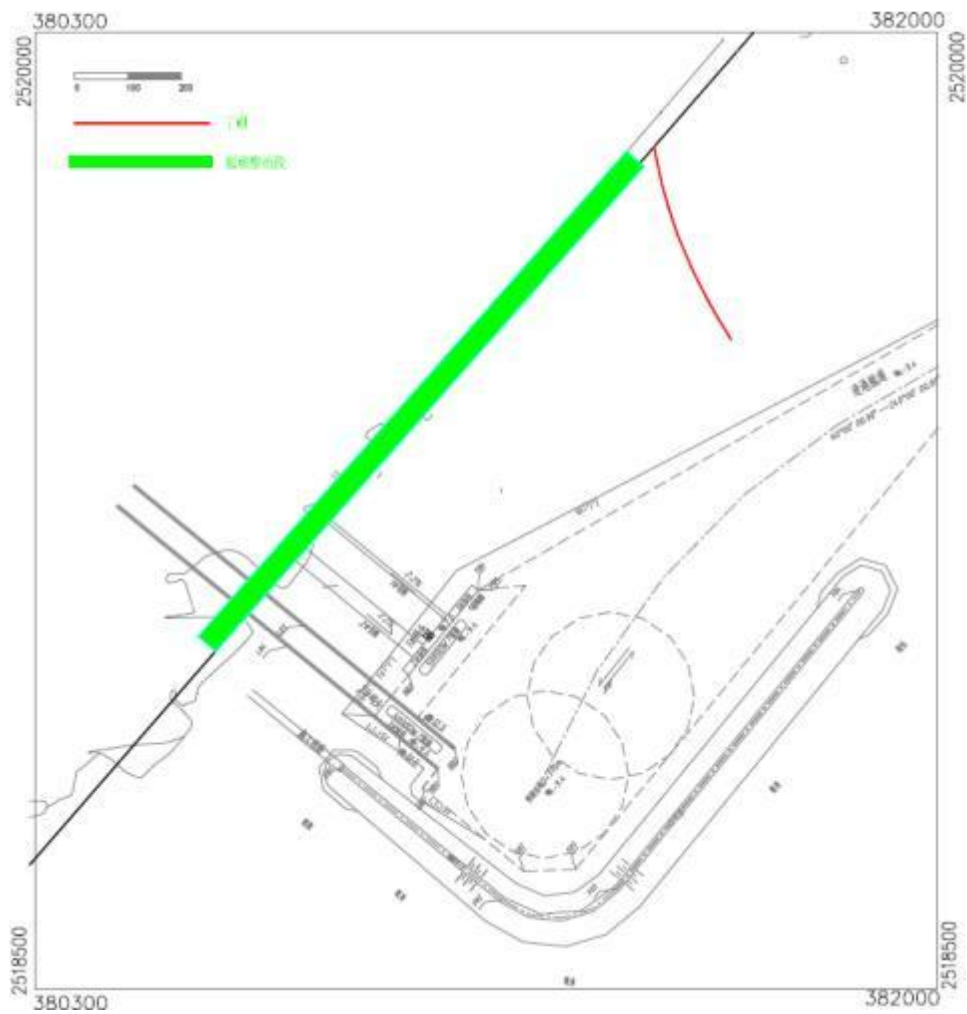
岸滩侵蚀防护基本方案布置示意图
